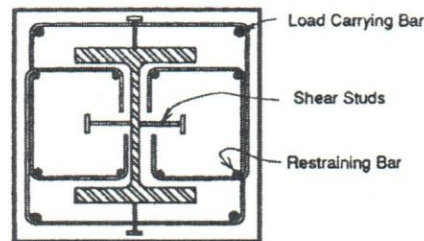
Ejemplo de un detalle de estribo cerrado para columnas mixtas embebidas²⁰
